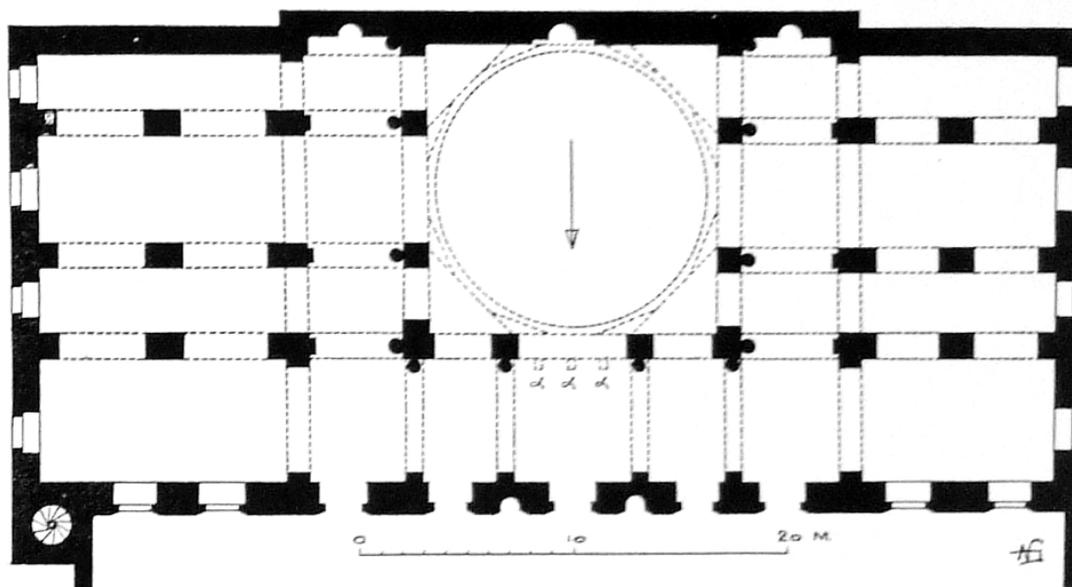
Silvan, Ulu Cami. Ricostruzione della pianta (da Gabriel, 1940).
